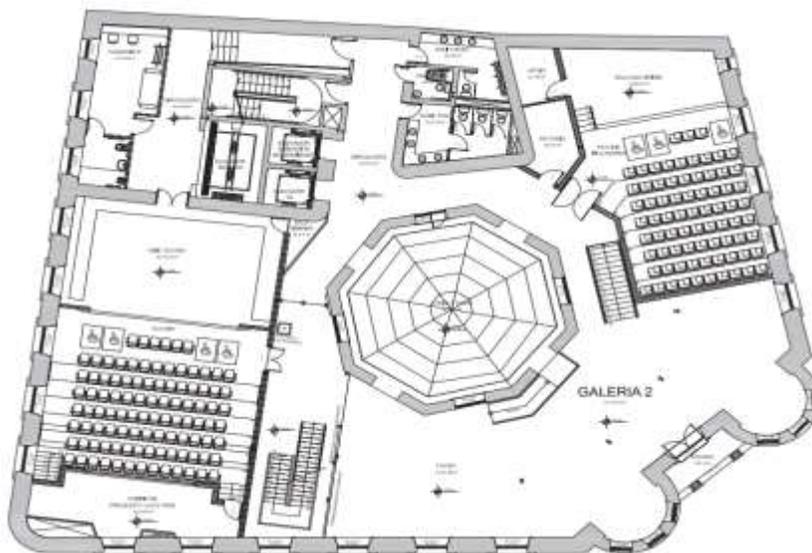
Planta Baixa Pavimento Térreo - Caixa Cultural
